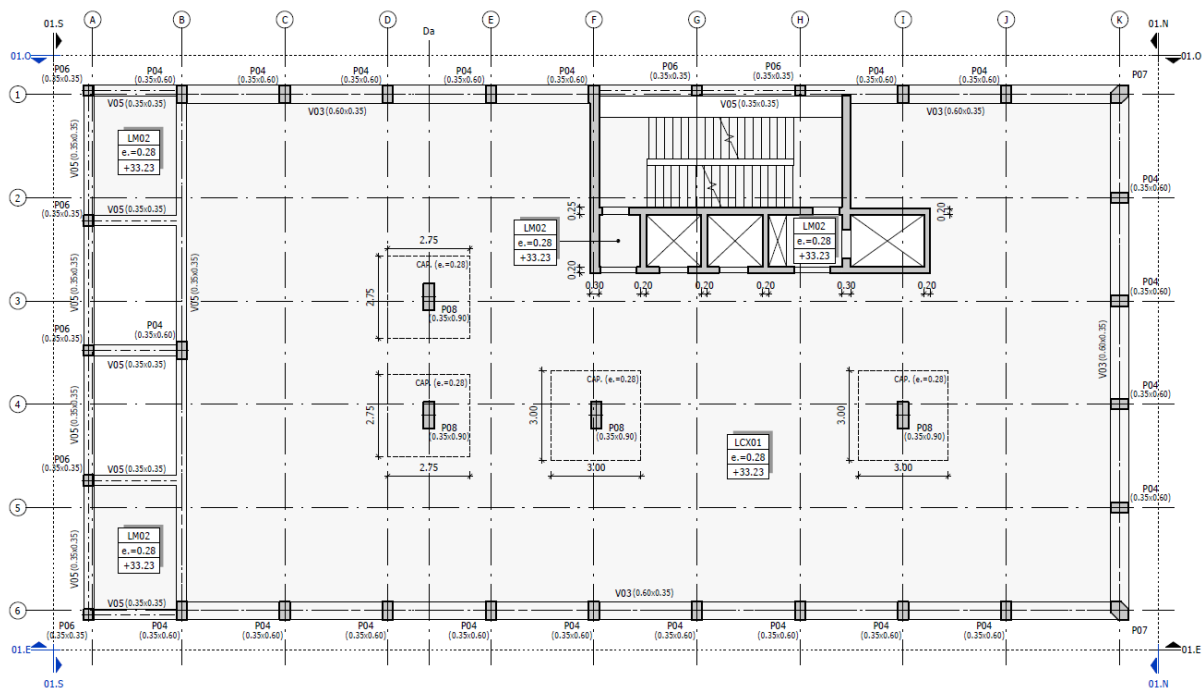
Planta estrutural Pisos Pares (Revit)
